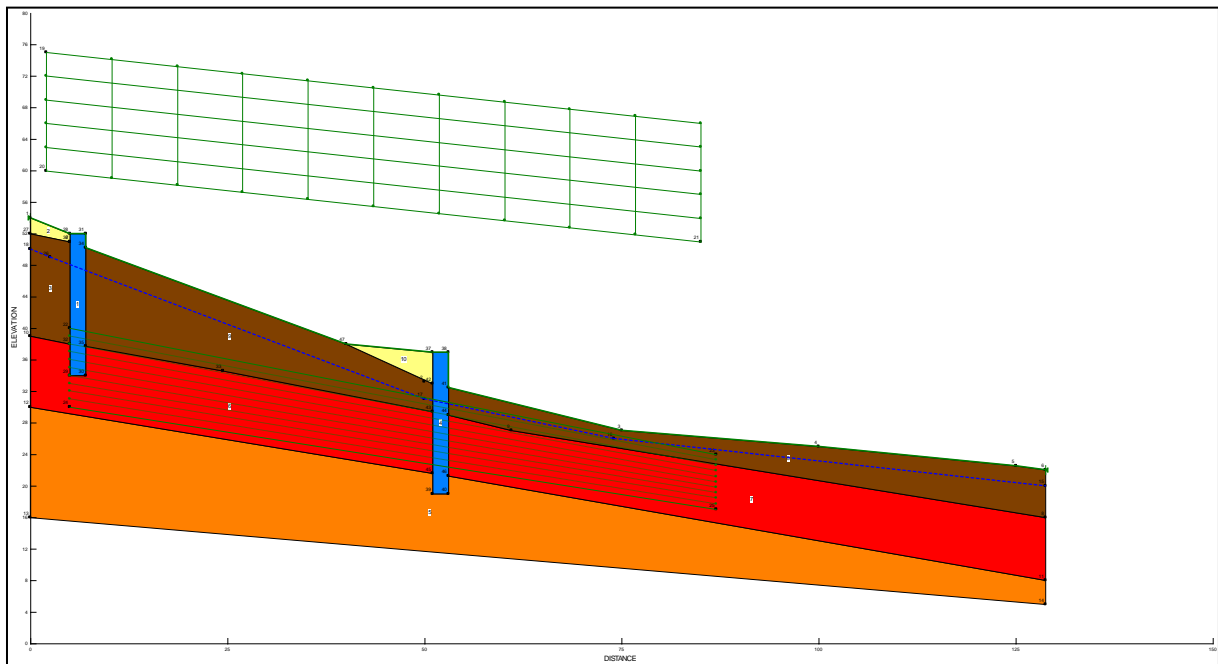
Talus conforté par deux murs de soutènement reposant sur pieux, avec la prise en charge de l'effet de drainage (Geoslope)
